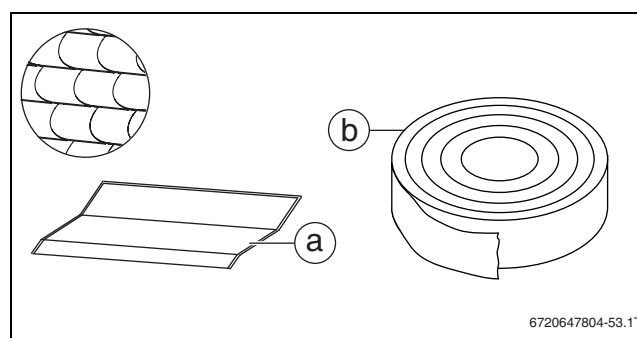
Komponenten für Dacheindeckung Schiefer/Schindel
